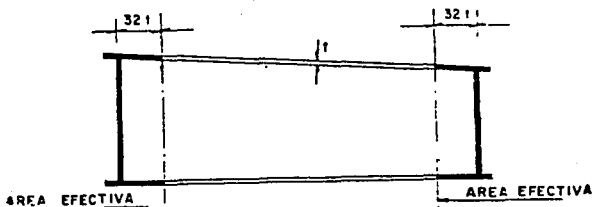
Area efectiva de la sección de pontón con capacidad estructural.
